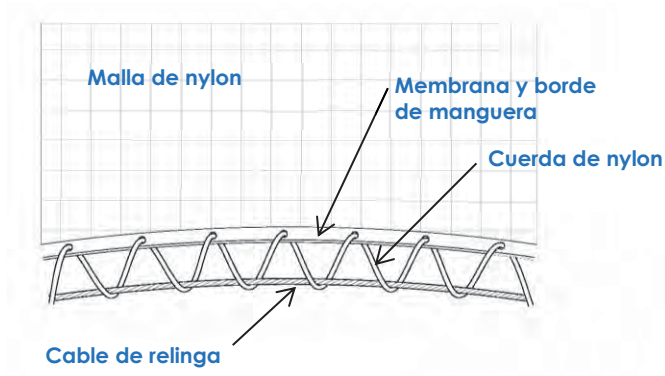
Detalle de sistema acordonado en cables de relinga.
